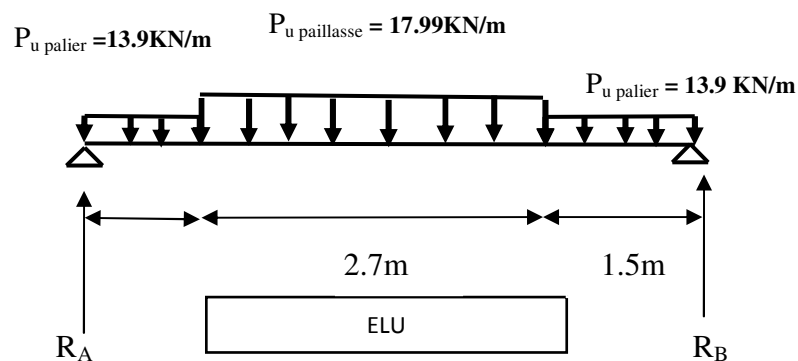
Schéma statique de l'escalier type 02 à ELU
